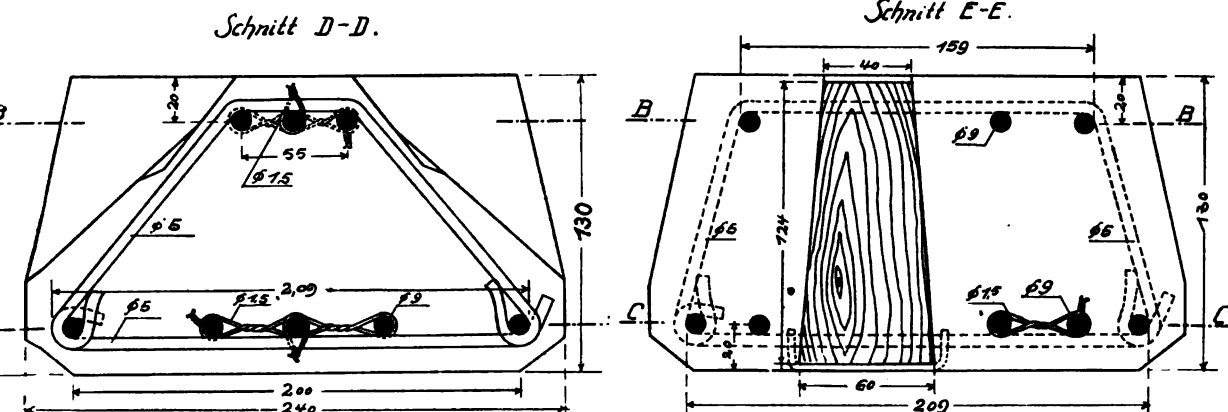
bis 91. Querschnitte der Maciachini-Schwelle.
